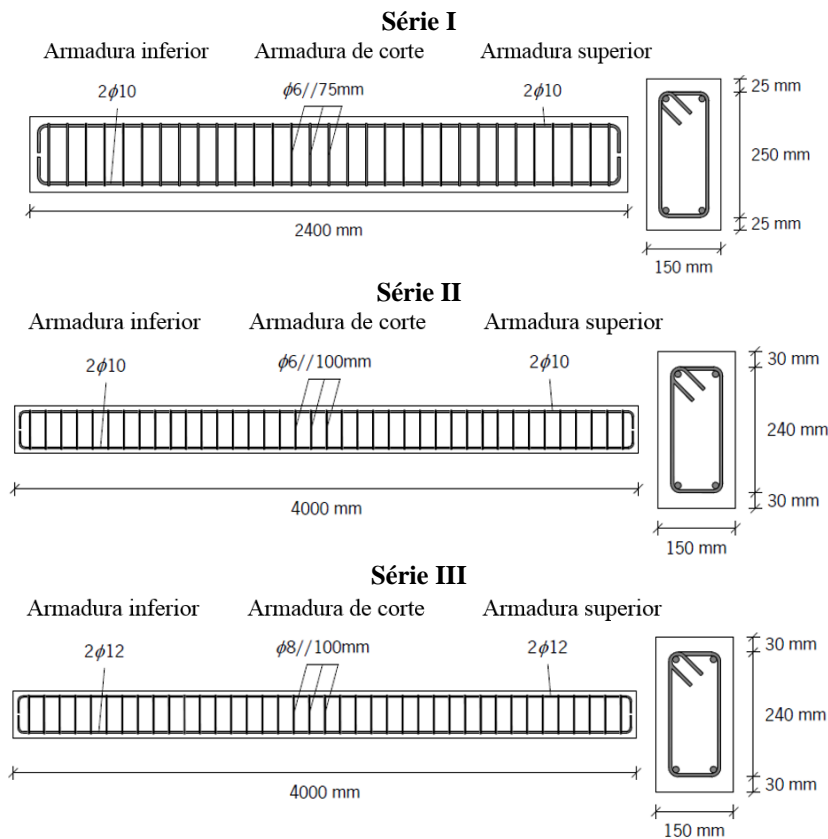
Geometria e armaduras das vigas ensaiadas por Costa (2014).
